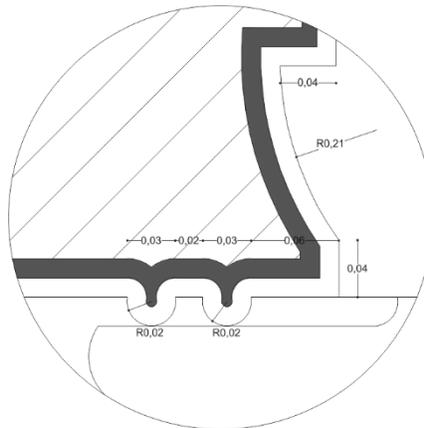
Detalle 3, detalle cornisa, Estación del ferrocarril Sur.
